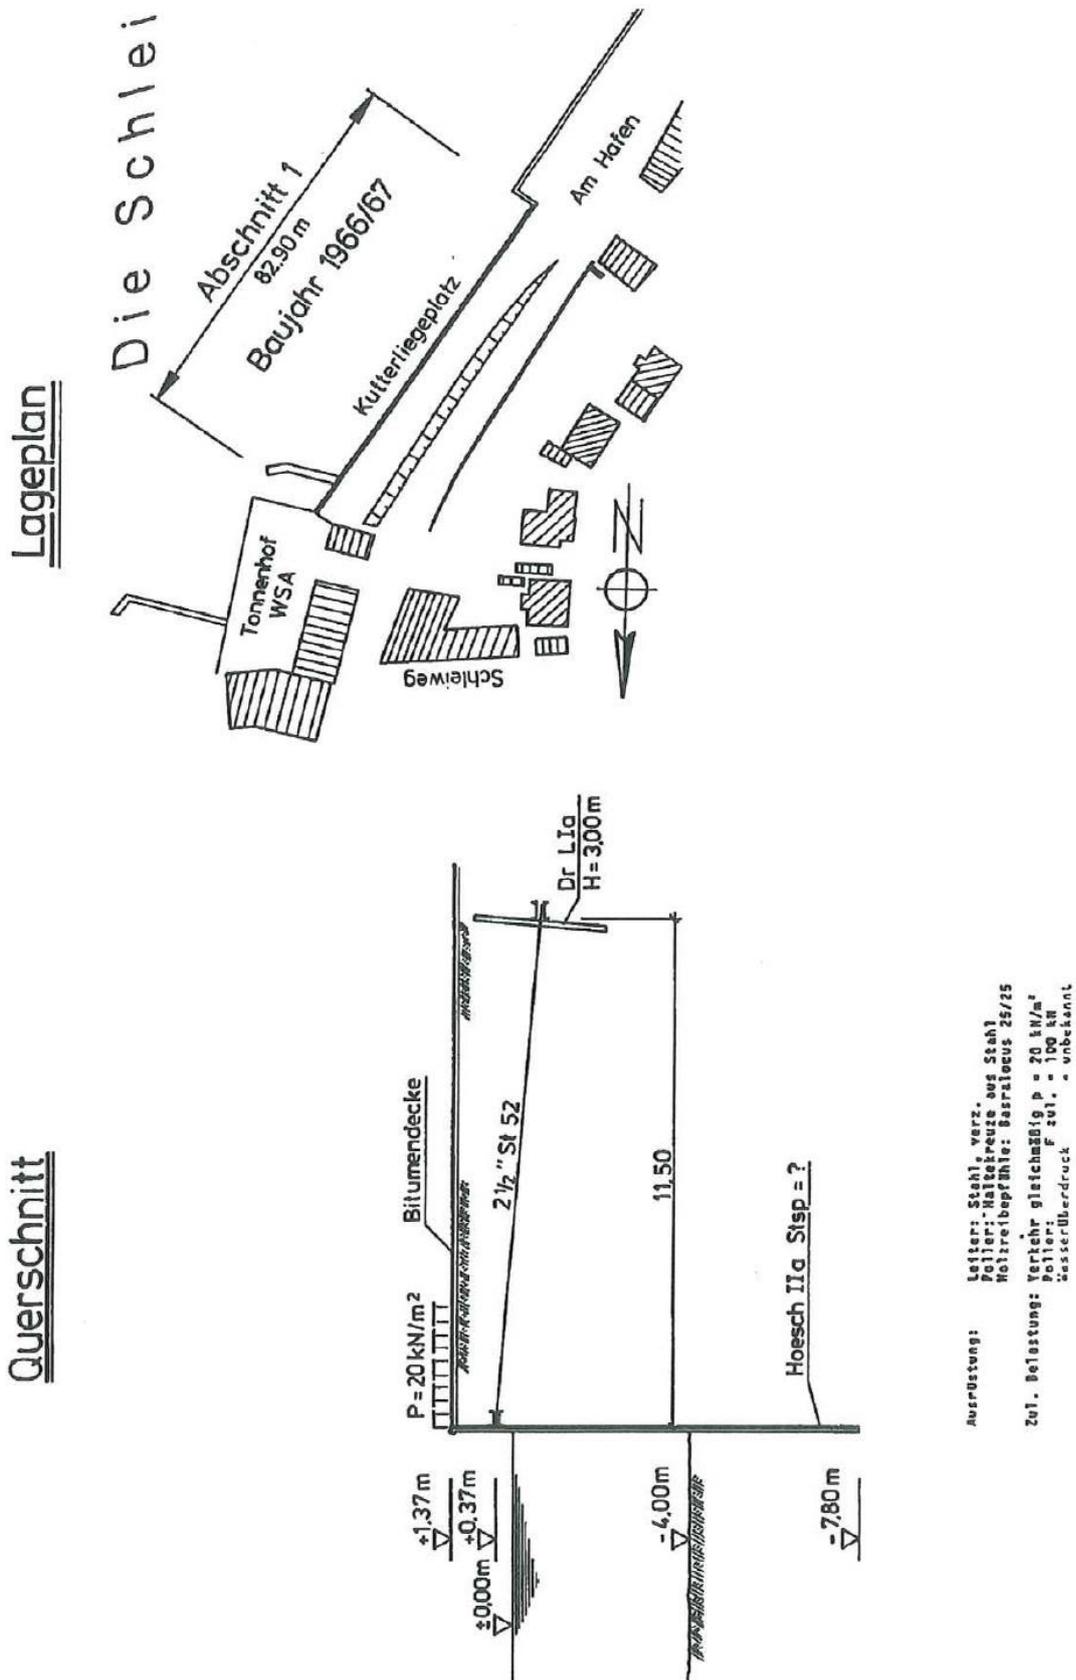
Querschnitt und Lageplan Kutterliegeplatz
